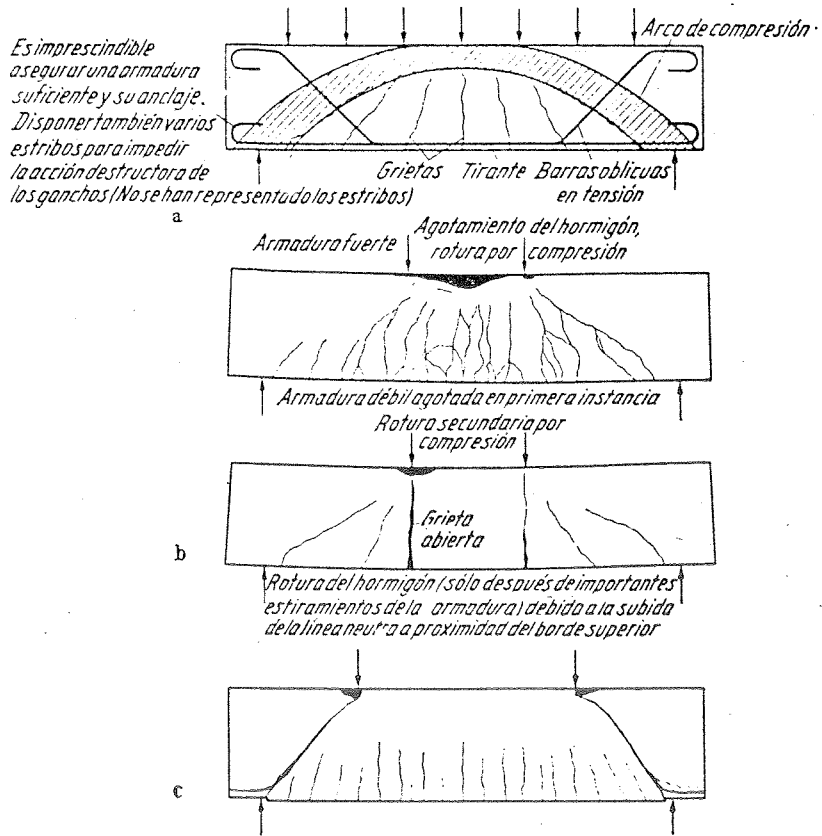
Ruína de Vigas de Concreto Armado Diferentemente Armadas (FRANZ, 1970)
